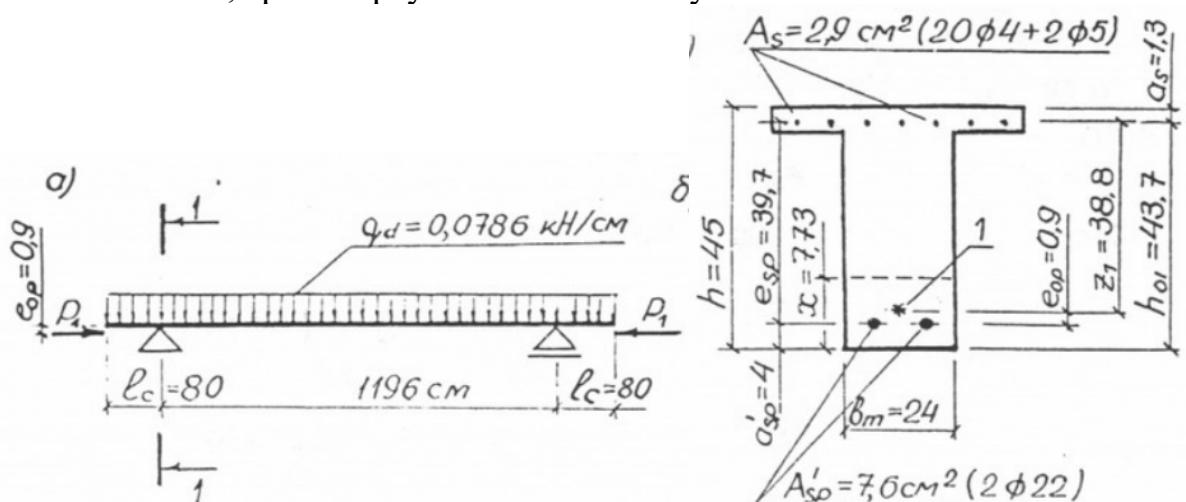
Розрахункова схема та розрахунковий переріз панелі покриття ждя стадії виготовлення та підняття
